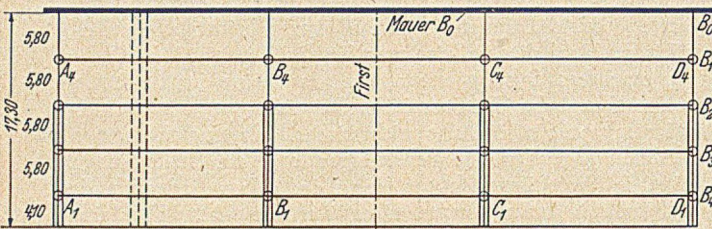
Der Grundriß der eingestürzten Halle mit ihren fünf Binderreihen B₁—B₅ und der massiven Hausmauer B.
